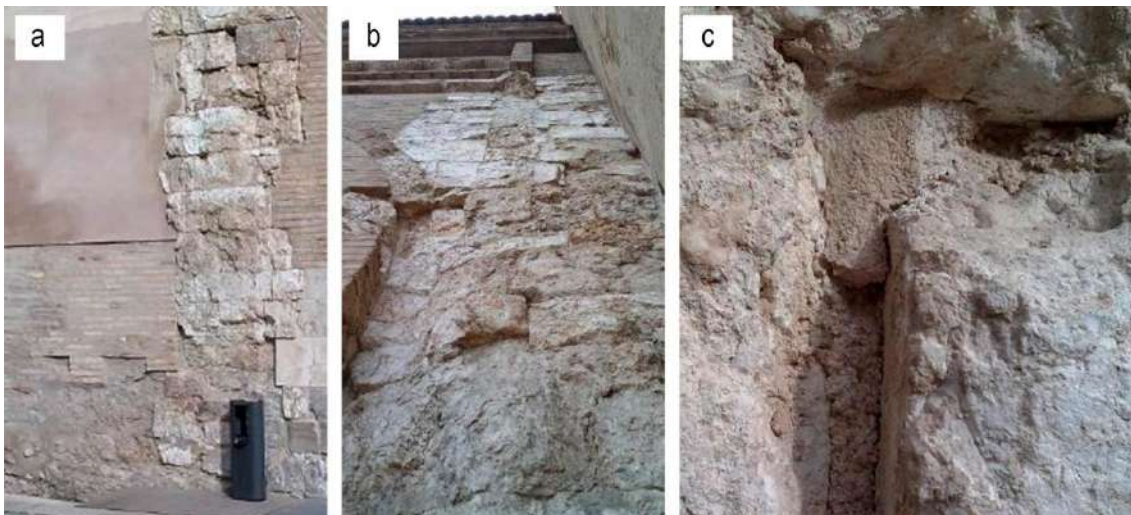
a) - c) Fachada exterior del Palacio de la Aljafería (Zaragoza, siglo XI), mostrando los muros de mampostería de piedra con juntas de yeso. Fotografías del autor.
